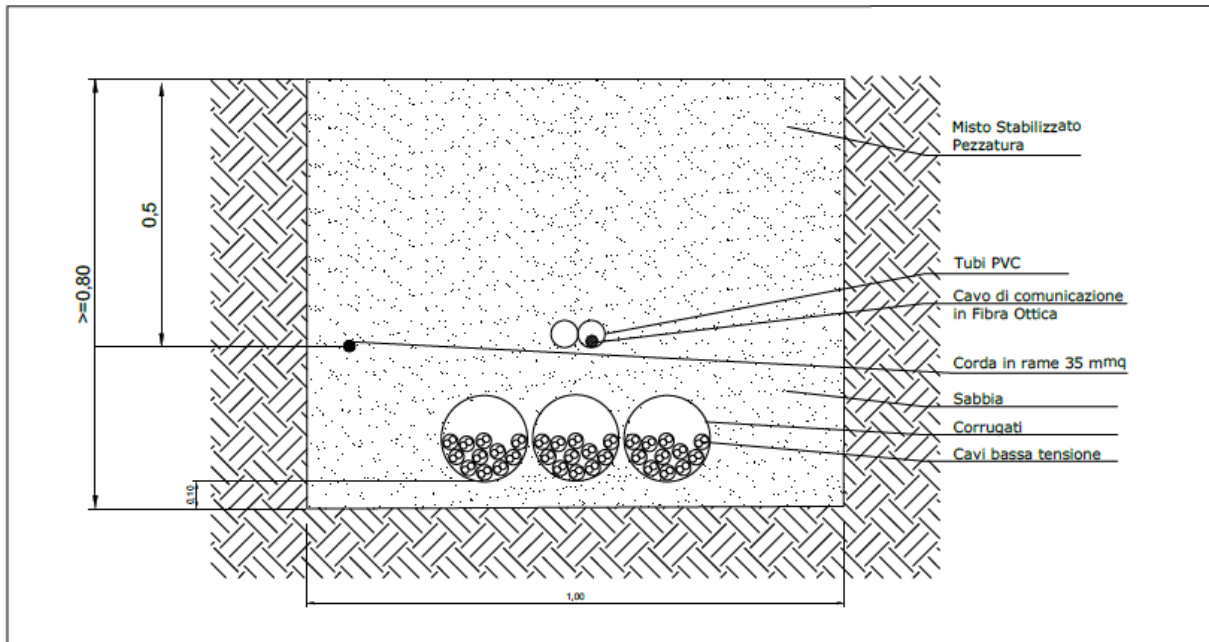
Sezione della trincea di scavo interna all'area d'impianto
